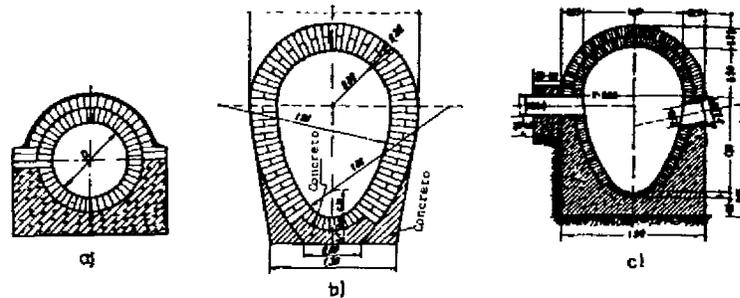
21: Secciones de alcantarillas de ladrillos /26/
